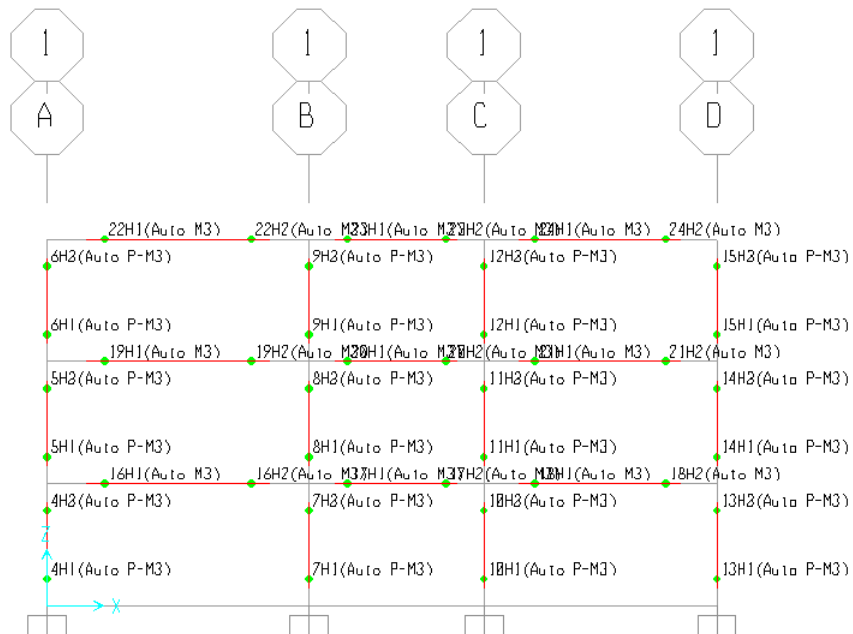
Rótulas Plásticas asignadas a vigas y columnas.
